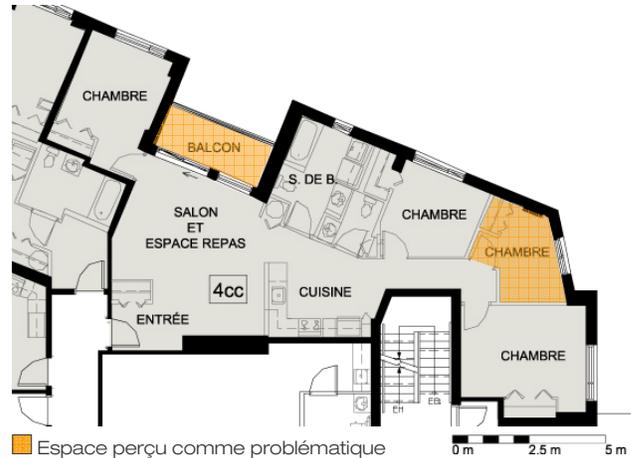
Plan d'un logement 4CC, rez-de-chaussée
